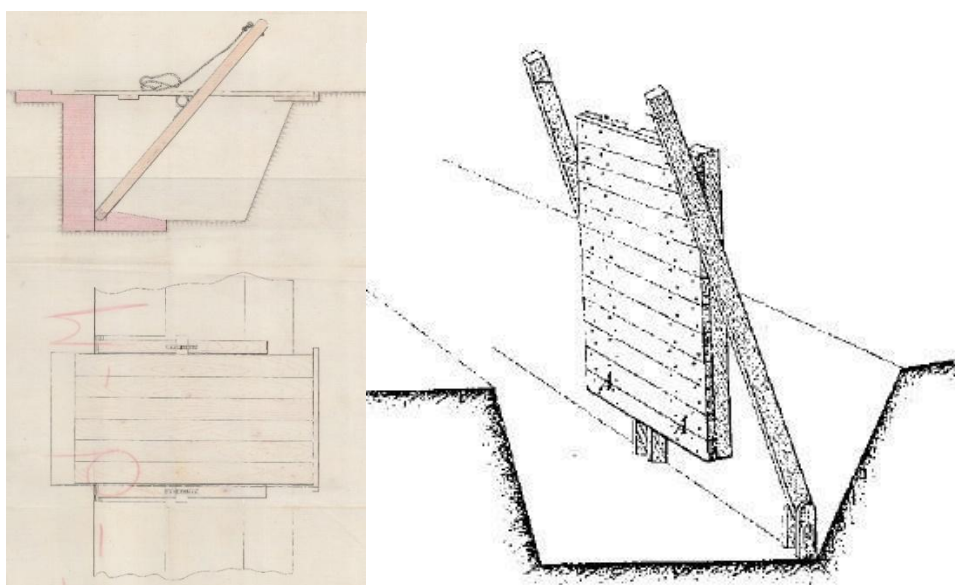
A mano izquierda, imagen del puente levadizo trazado para el fuerte de la Princesa de Asturias (IHCMET, NA-21-14); Figura 162. A mano derecha, la ilustración de un puente levadizo de un foso de blockhaus (Soroa, 1898: Lámina XIV, Figura 126)
